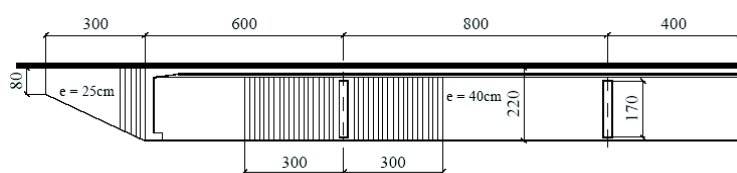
Corte longitudinal da ponte: Modelo Estrutural II (unidades em cm)
